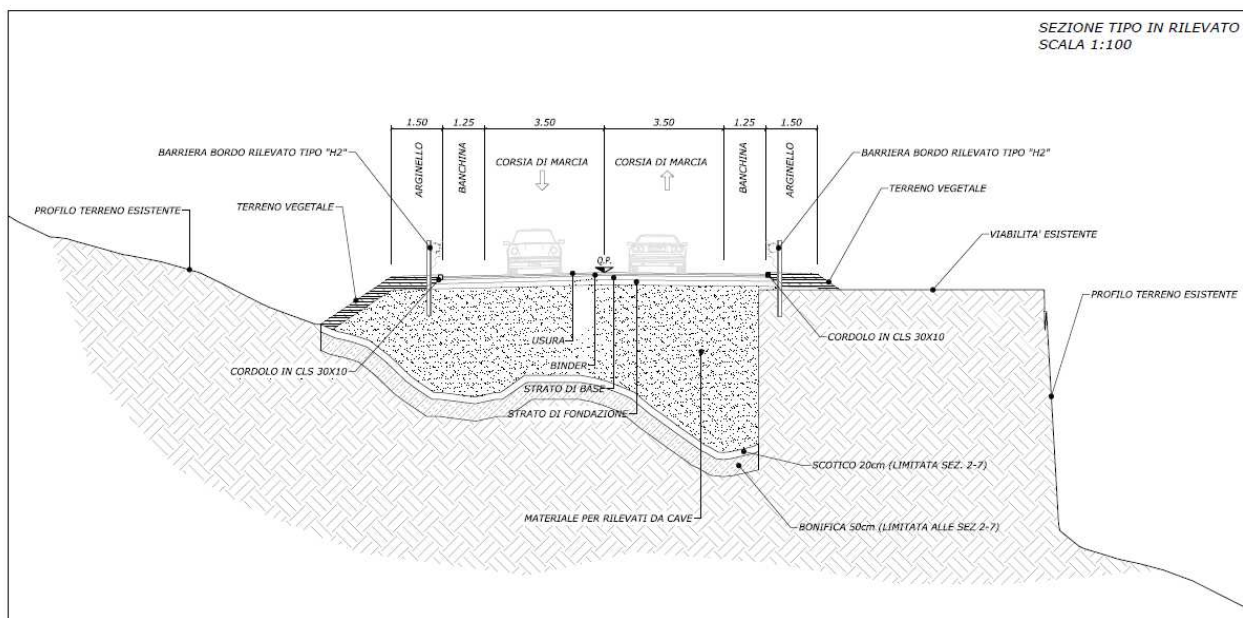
Sezione stradale di tipo C2 prevista per il lotto in oggetto
